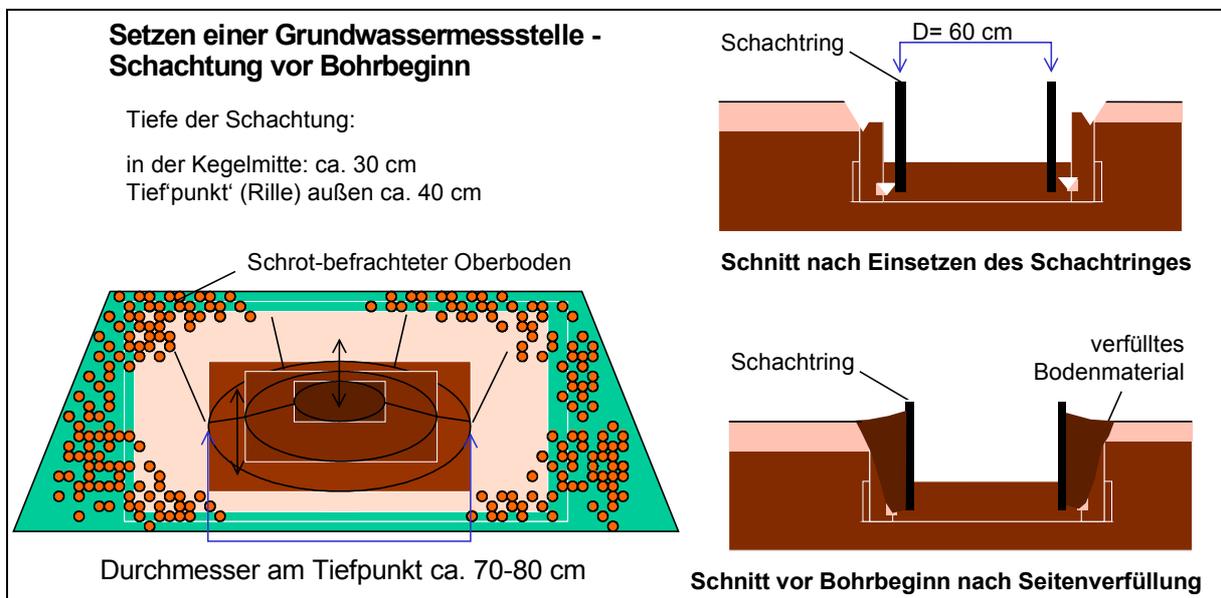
Vorbereitung einer Bohrung für eine Grundwassermessstelle
